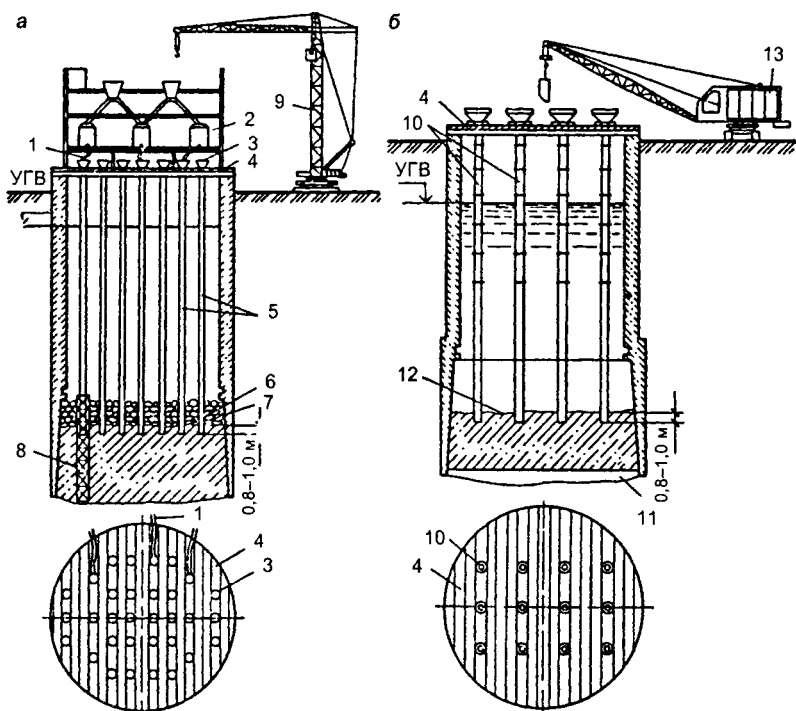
Схема подводного бетонирования подушки дна опускного колодца:
